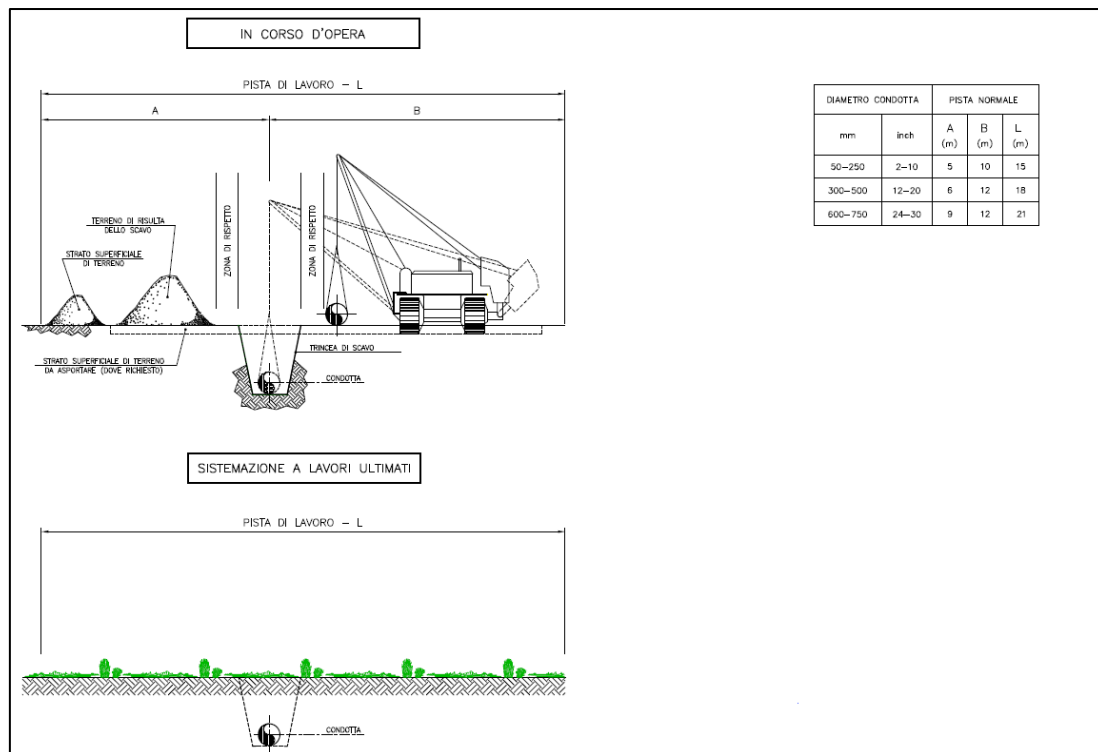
Sezione Tipica Pista di lavoro “Normale”
